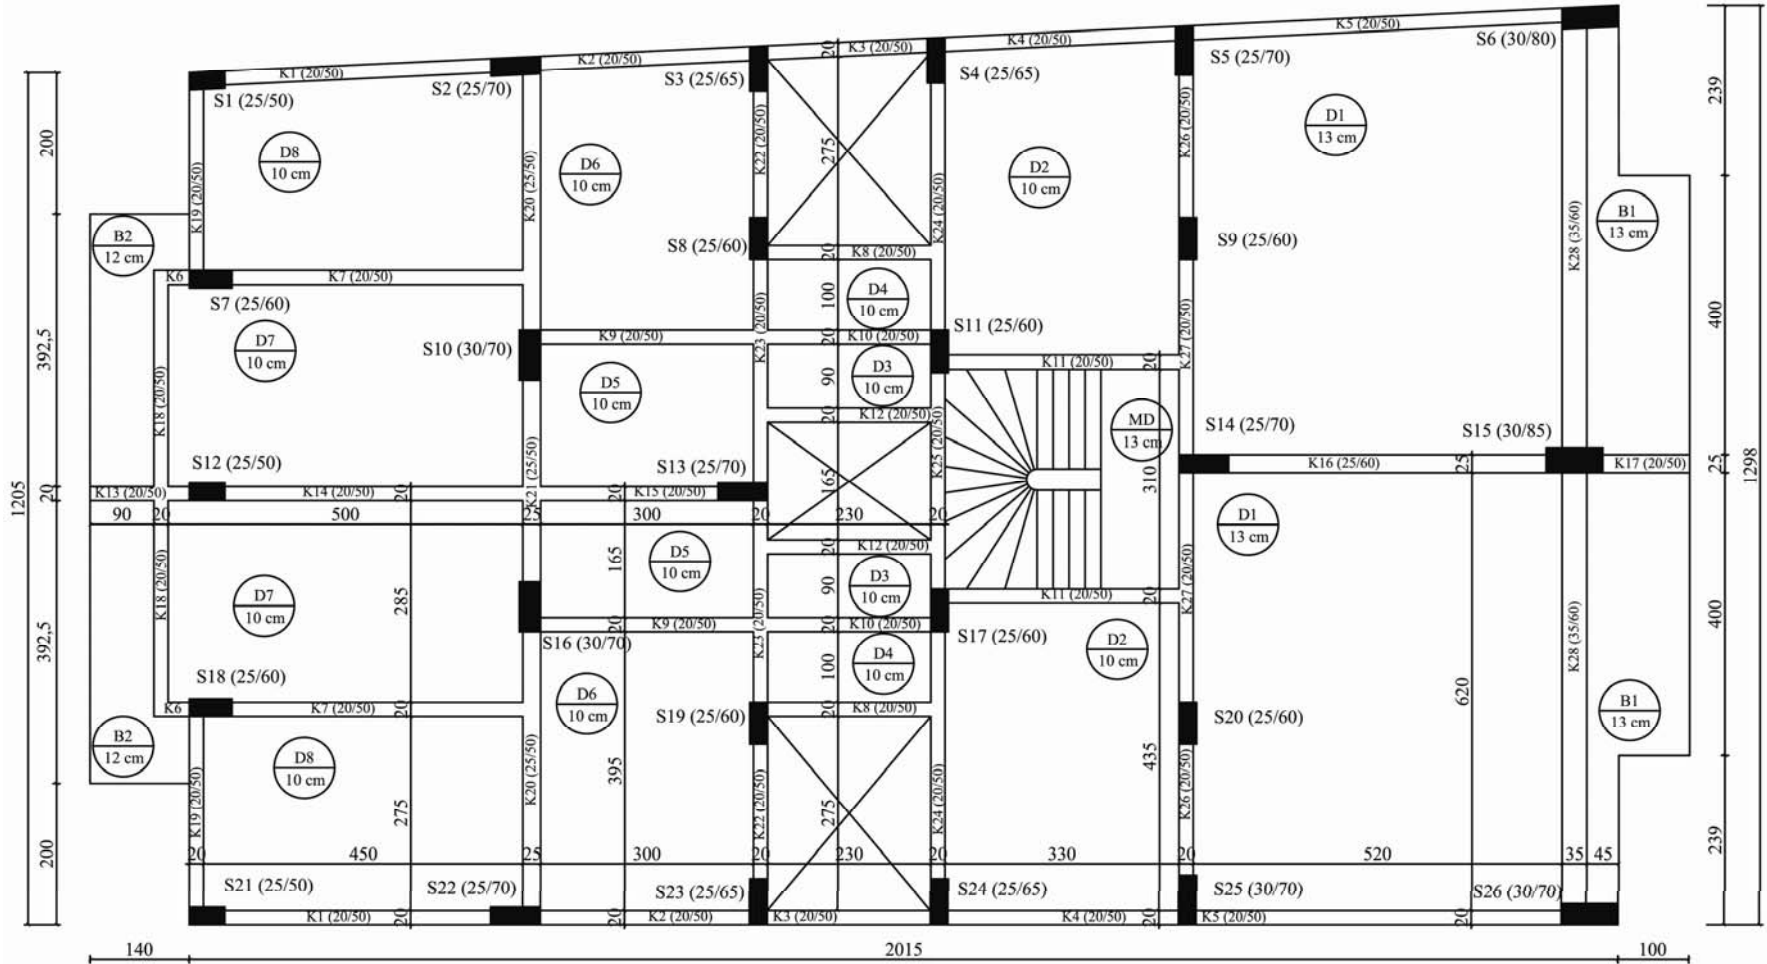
B4\_2'in kat kalıp planı
